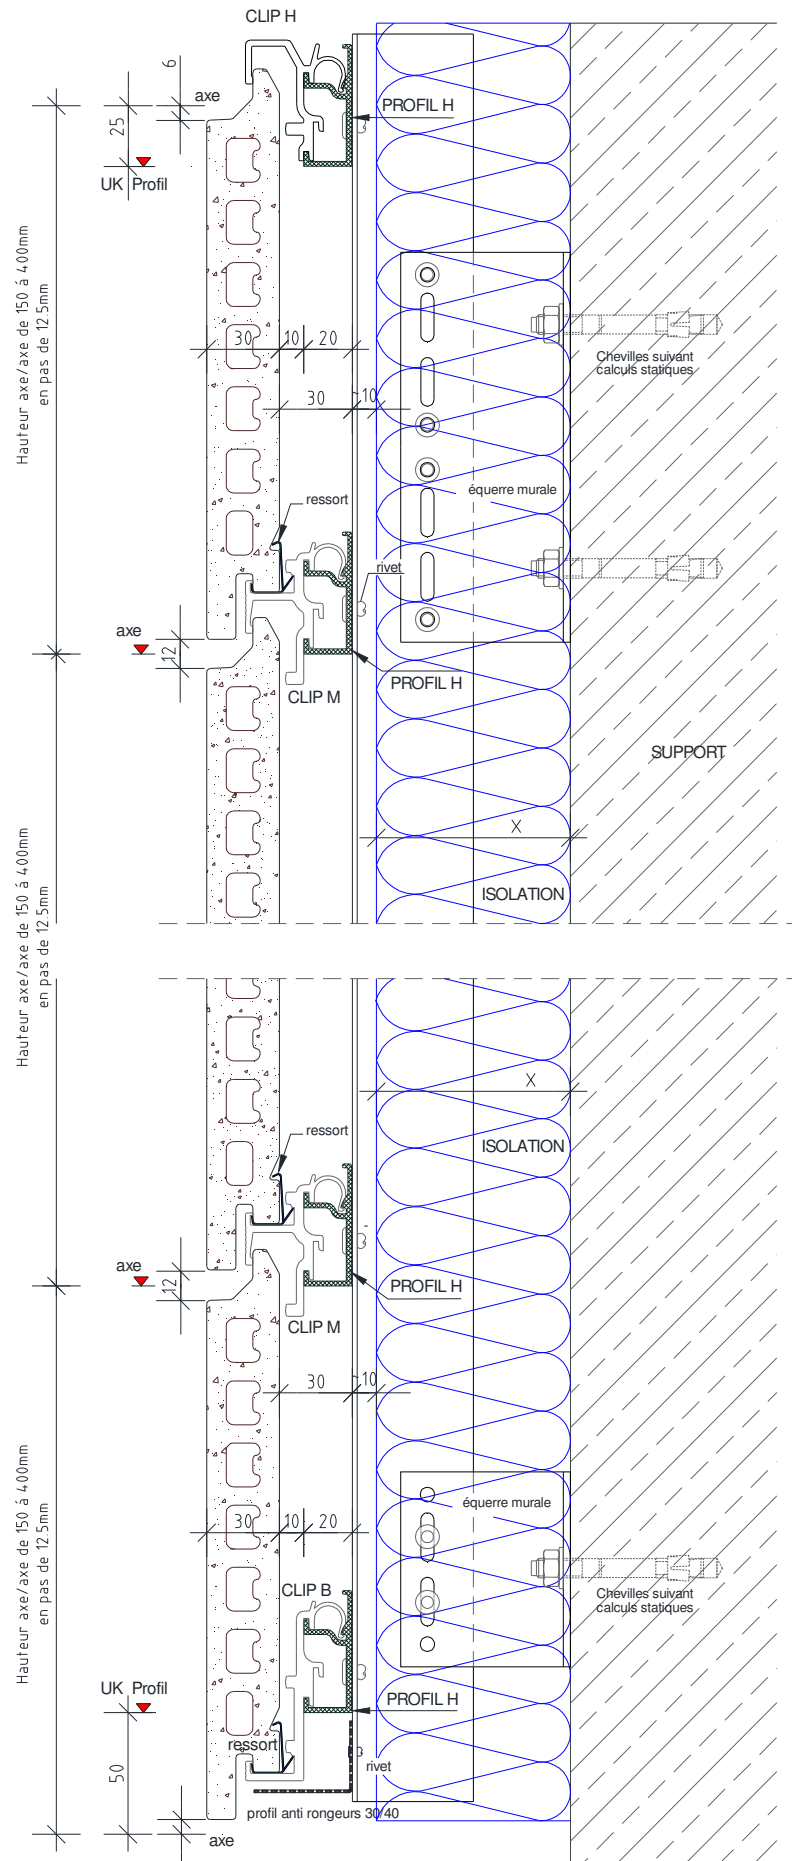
Coupe verticale - Pose avec rail portant horizontal 06'75
